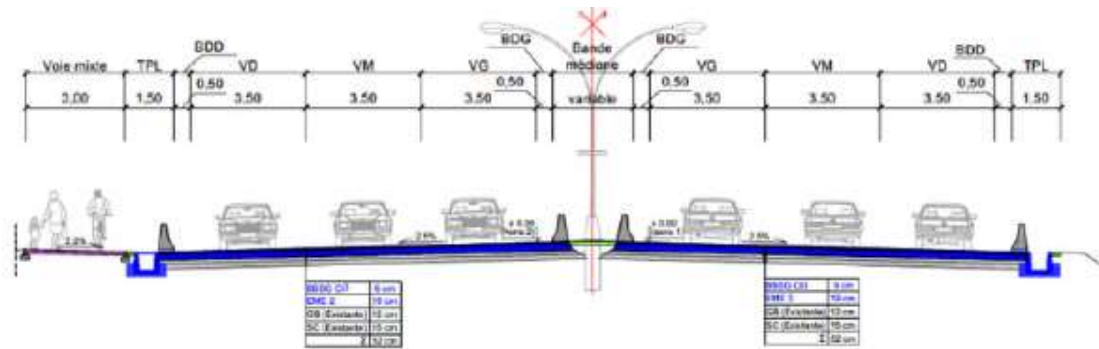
Profil en Travers - Section courante de Yopougon Express
